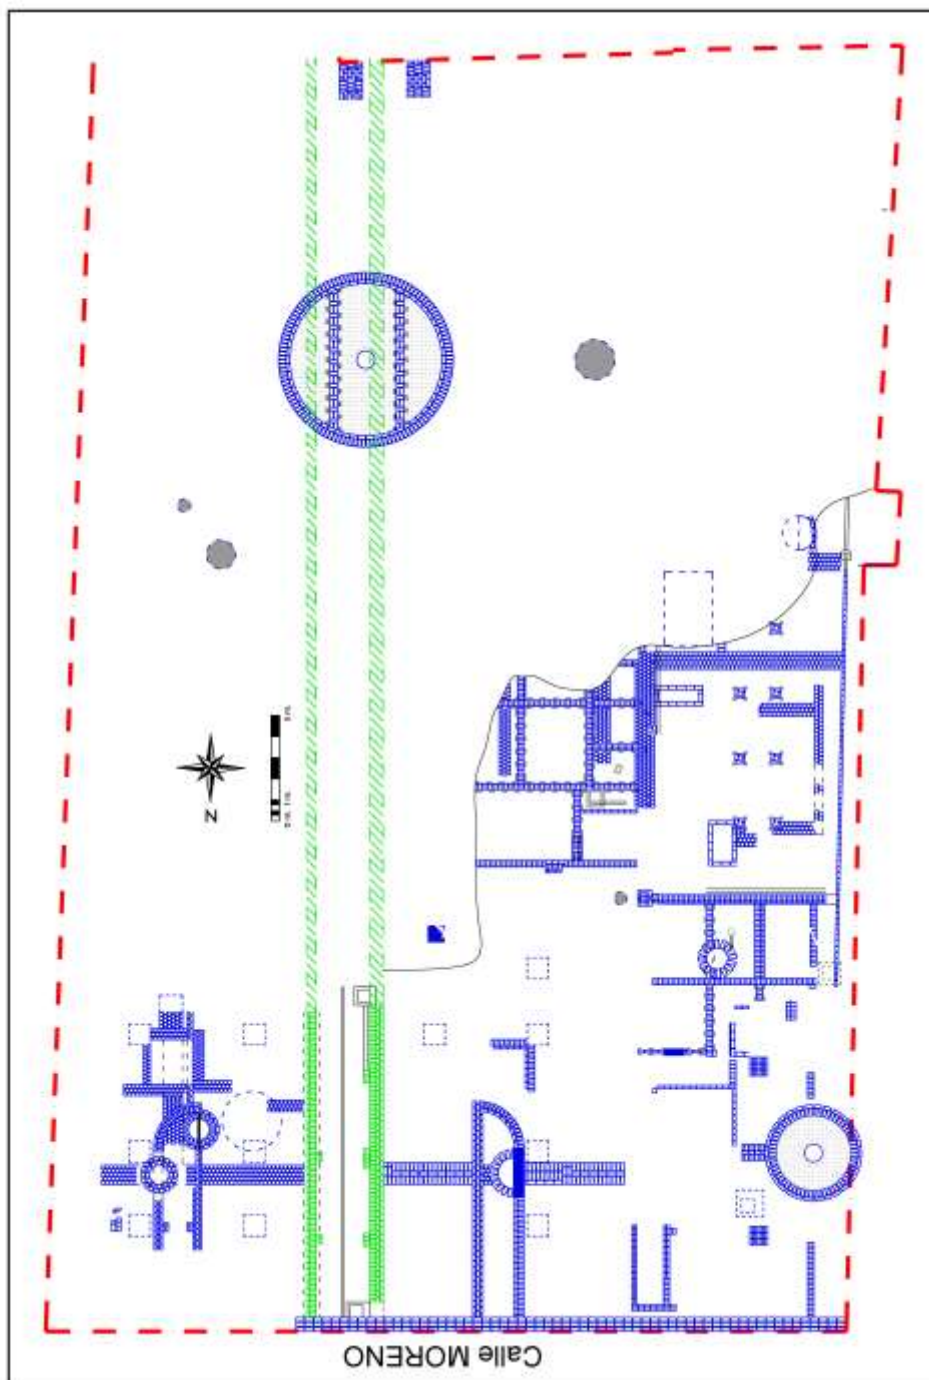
Planta de los restos de cimientos y estructuras enterradas relevadas durante los trabajos. En verde, el trazado que representa el pasillo de acceso del antiguo inquilinato y su proyección sobre los muros construidos en el interior de la cisterna.
